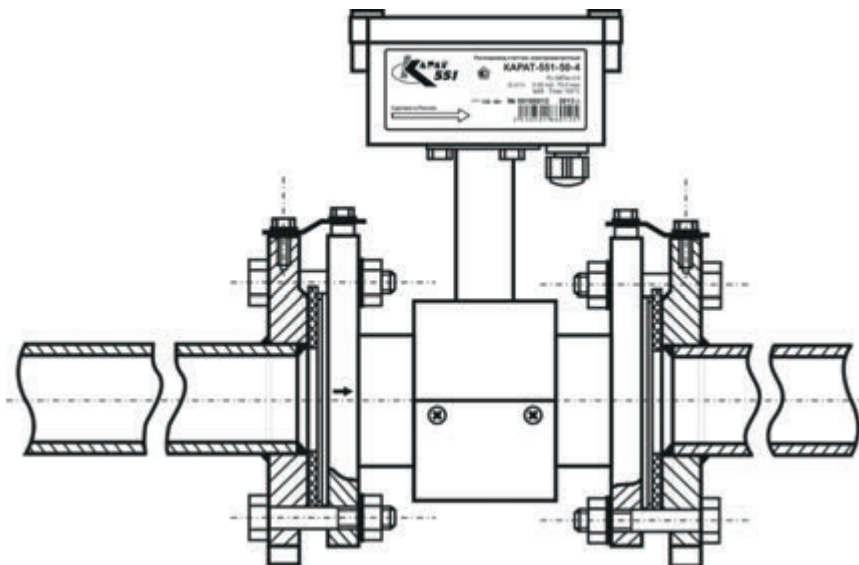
Схема установки в трубопровод фланцевых расходомеров
